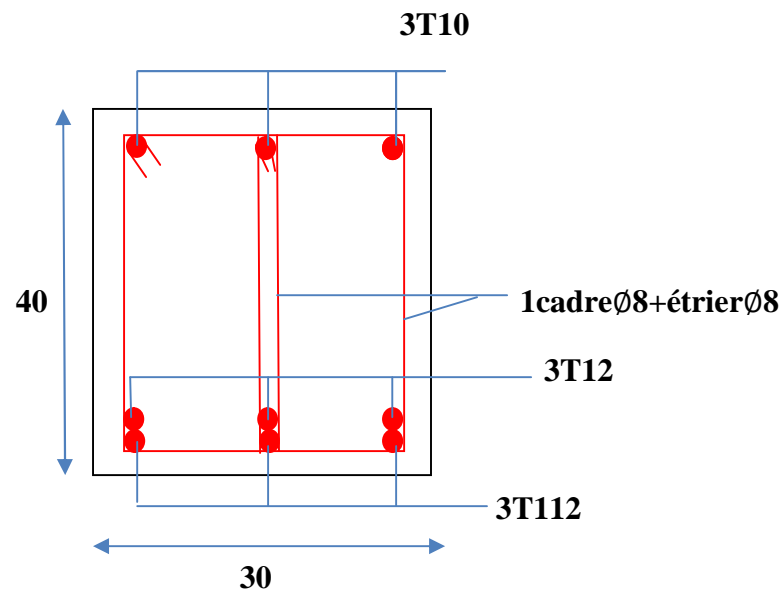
Schéma de ferrailage de la travée d'une poutre palière.
